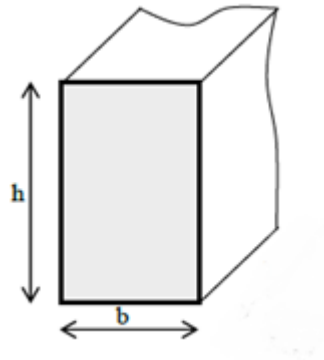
COUPE TRANSVERSALE D'UNE POUTRE SECONDAIRE
